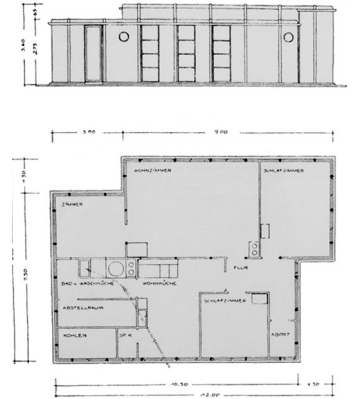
Planta y alzado de la *Stahlhaus*. En SPIEGEL, H., *Der Stahlhausbau*, Alwin Fröhlich Verlag, Leipzig, 1928, p. 94.
